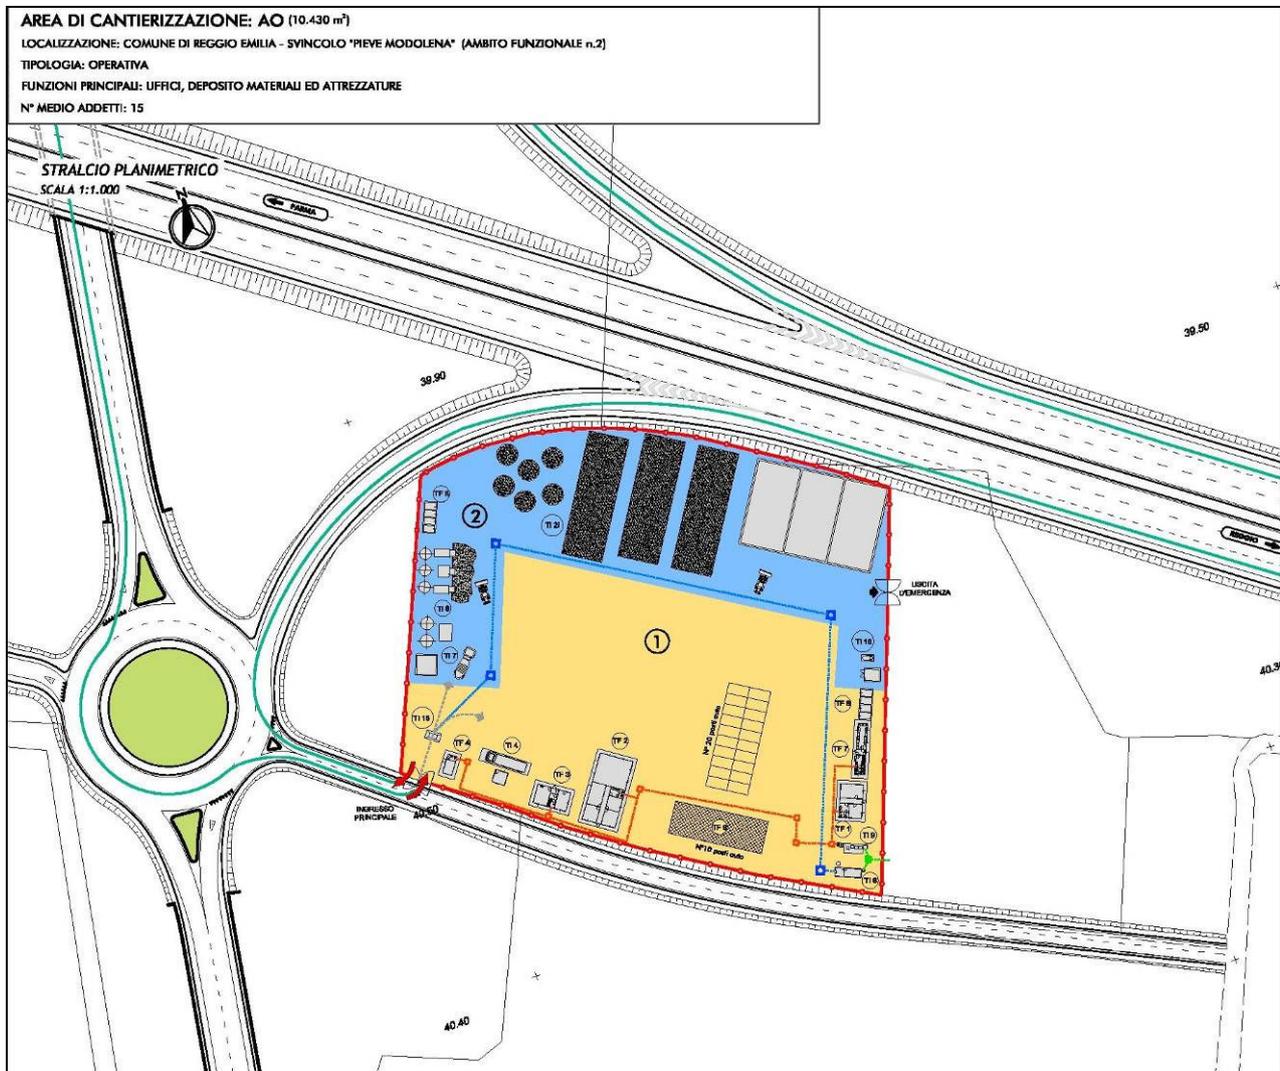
Layout aree di cantiere: area operativa Ambito 2 (stralcio planimetrico dell'elaborato T00IA24CANLF01A).
